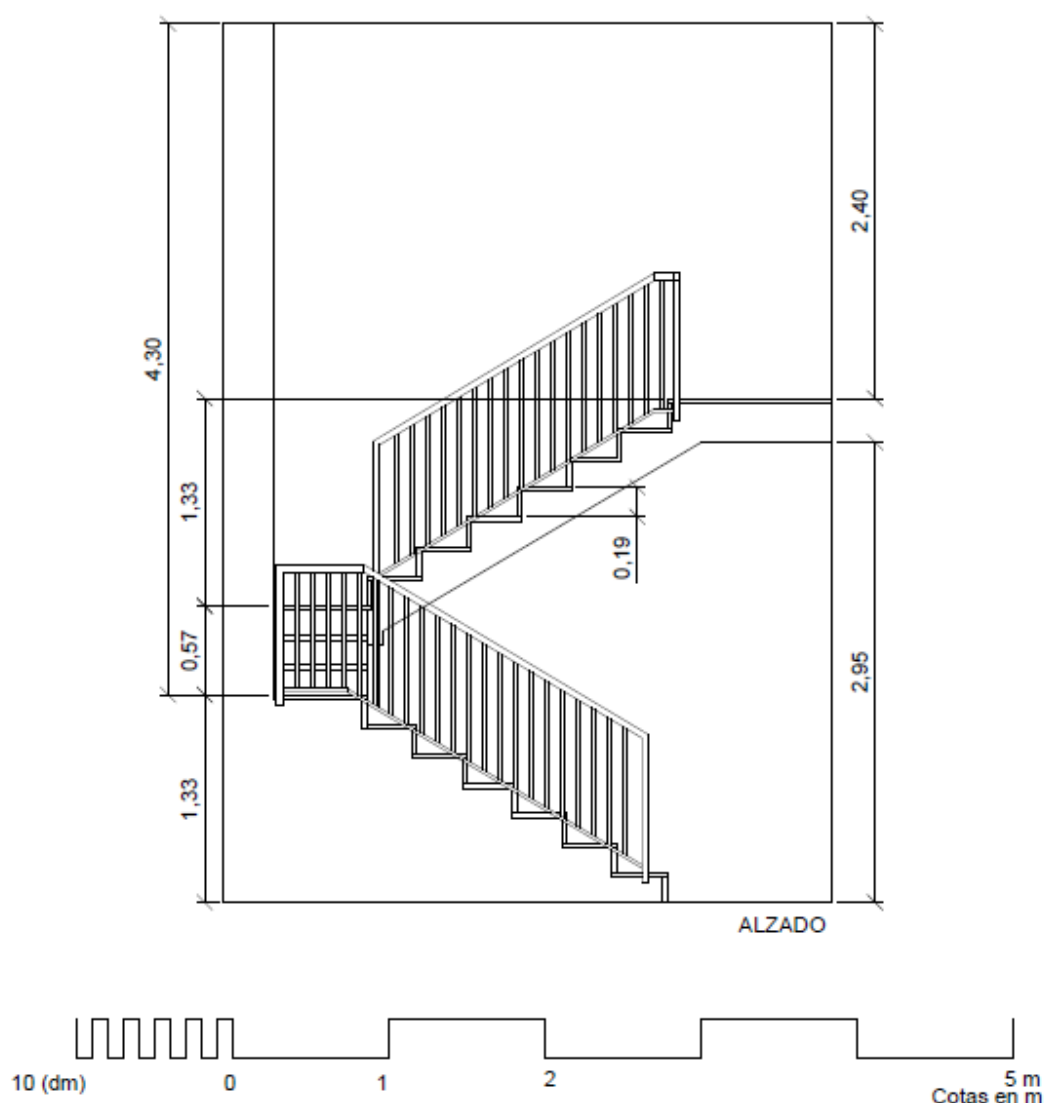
Alzado de la escalera. Fuente: Elaboración propia.
